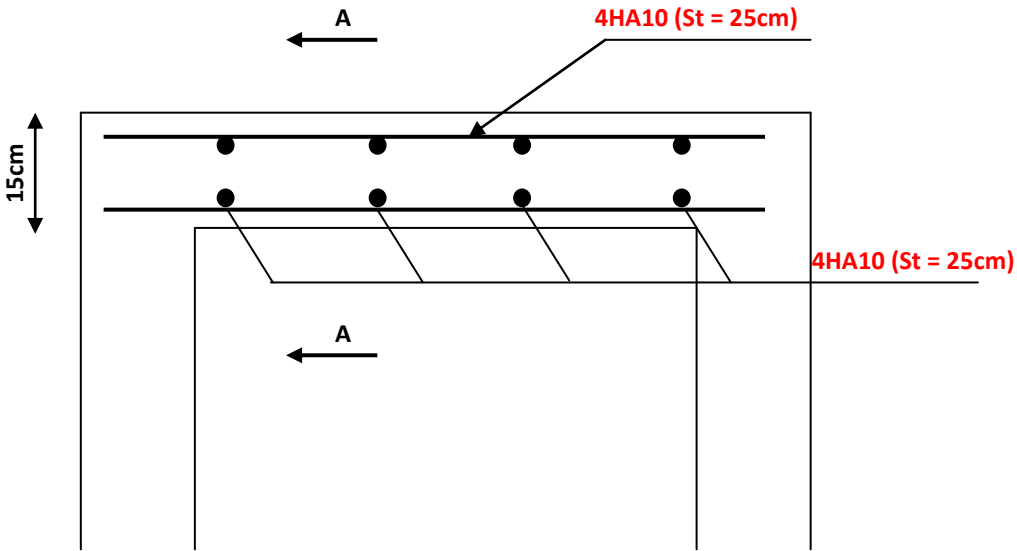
Ferrailage de la dalle de la salle machine
